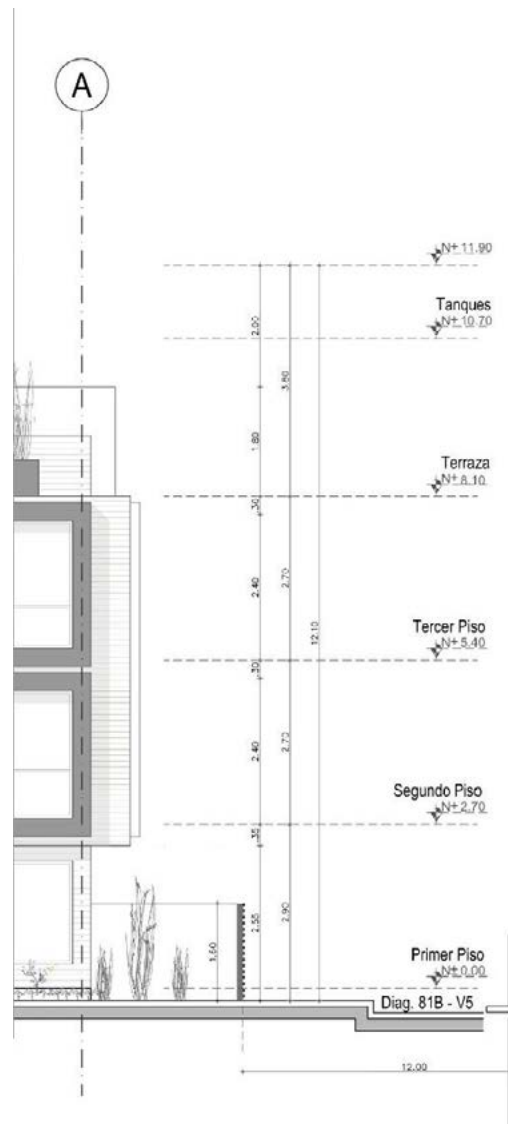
Fuente: (Porter & Greenstreet, 1987)
